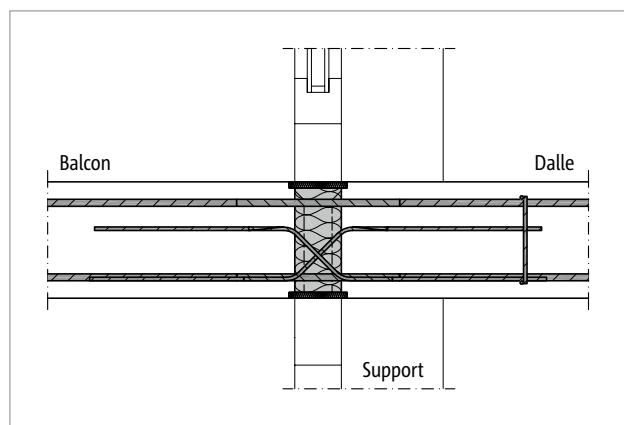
Schöck Isokorb® T Type D : Coupe de montage ; plancher plat
